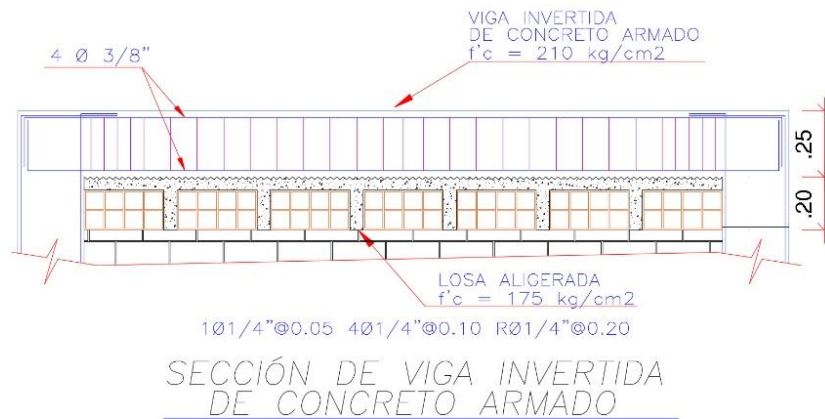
Propuesta del requerimiento de acero de refuerzo en las vigas de confinamiento (propuesta variable de acuerdo a criterio profesional)
